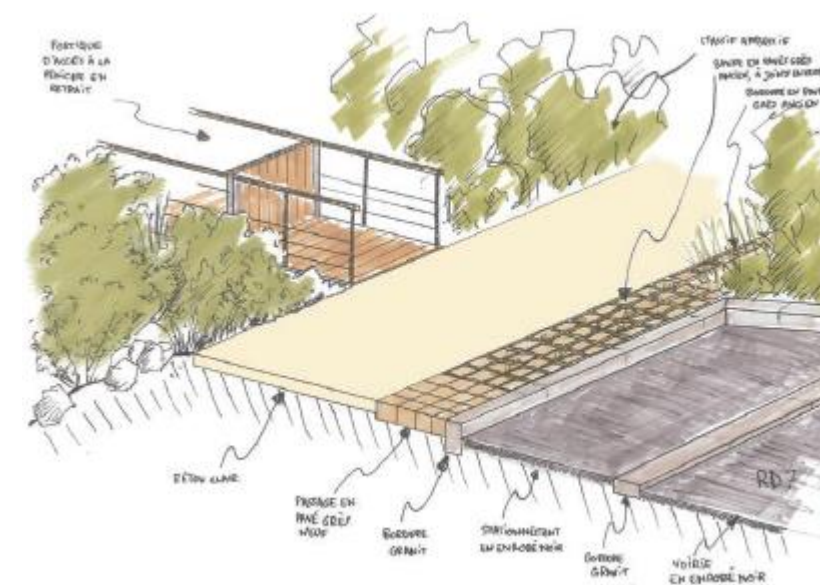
Principe d'agencement des matériaux sur la zone sans garde-corps
